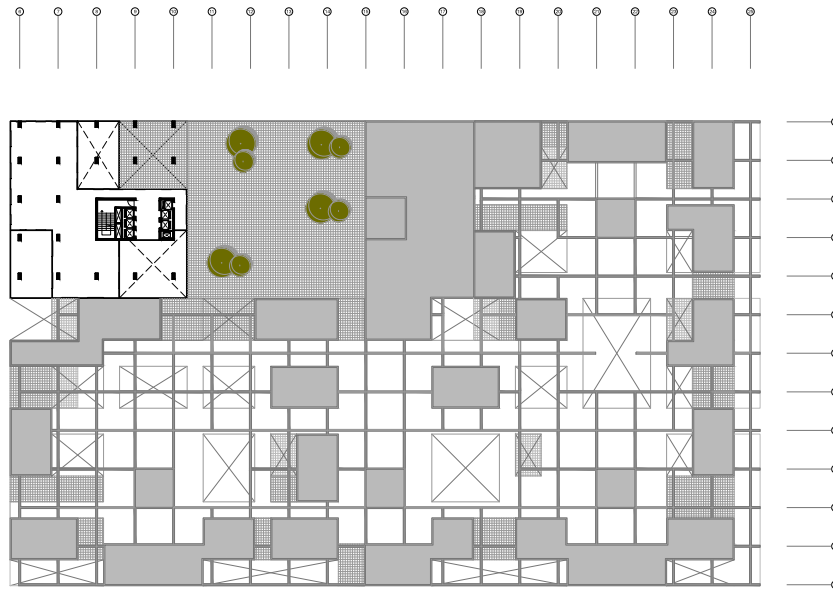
Planta N+/- 14.40 m (elaboración propia)
